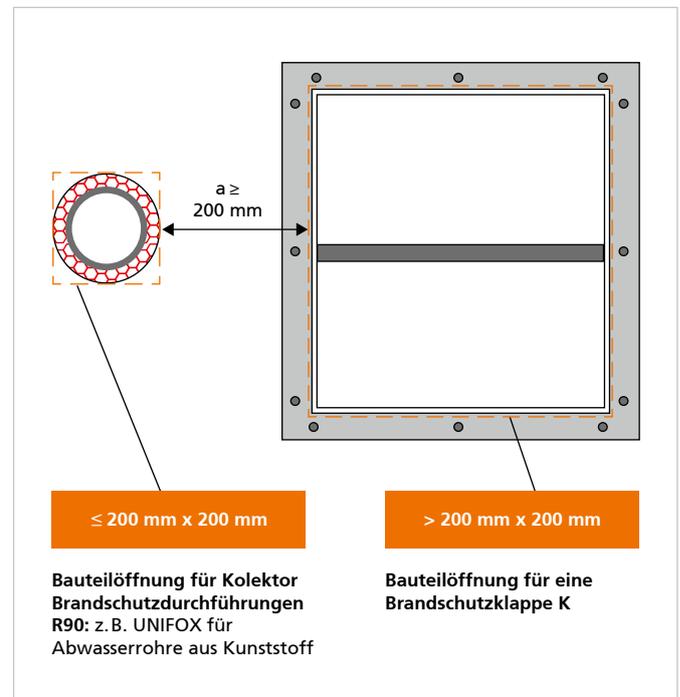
Abstand zwischen zu verschließenden Bauteilöffnungen zu anderen Öffnungen oder Einbauten. (Wenn beide Bauteilöffnungen ≤ 200 mm x 200 mm sind, genügt Abstand $a \geq 100$ mm)
